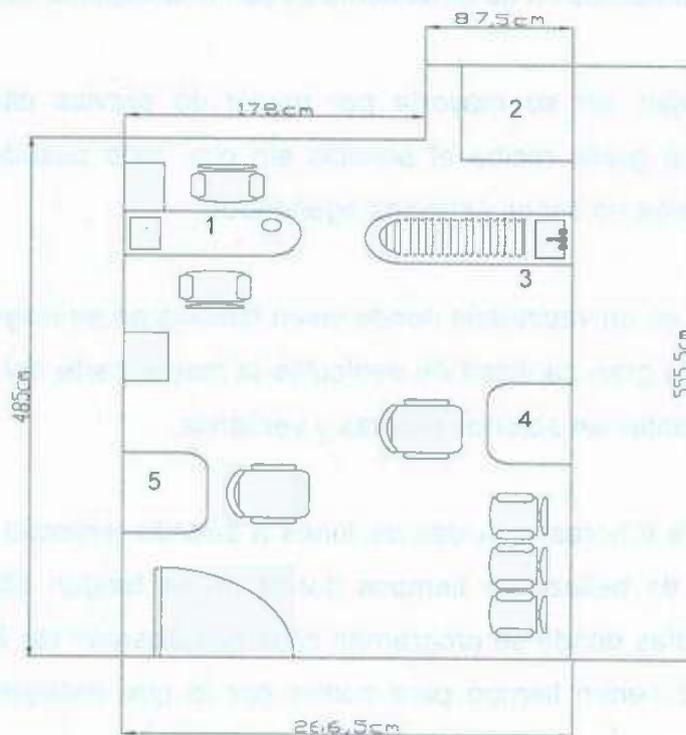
Layout del salón de belleza "Alma Rosa Salón"
